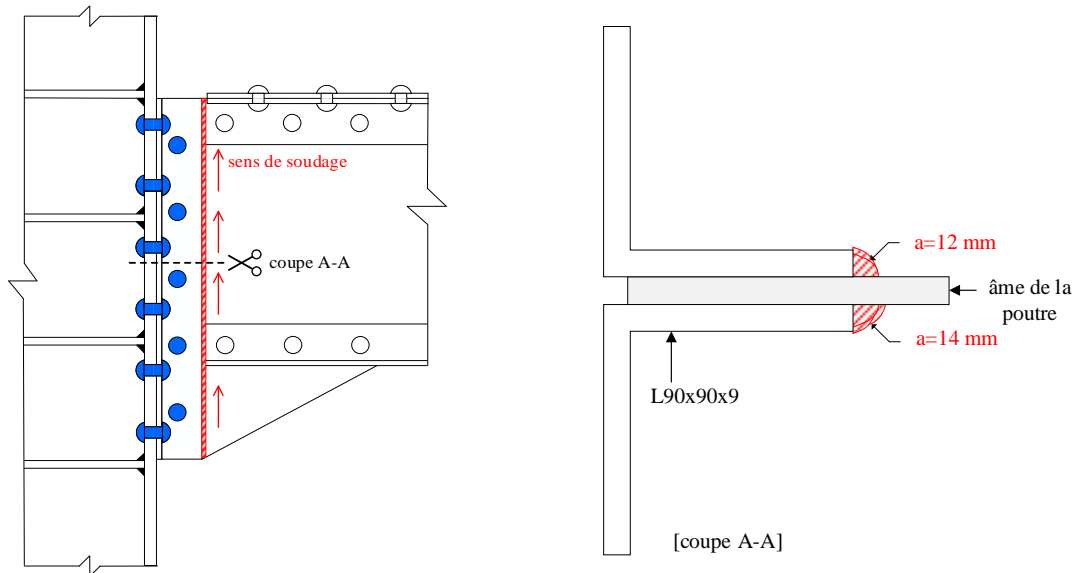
Soudage sur spécimen riveté AR-S-1
